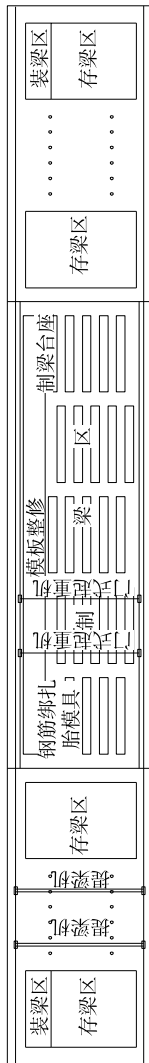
提梁机搬梁、运梁车经运梁通道出梁平面布置图
